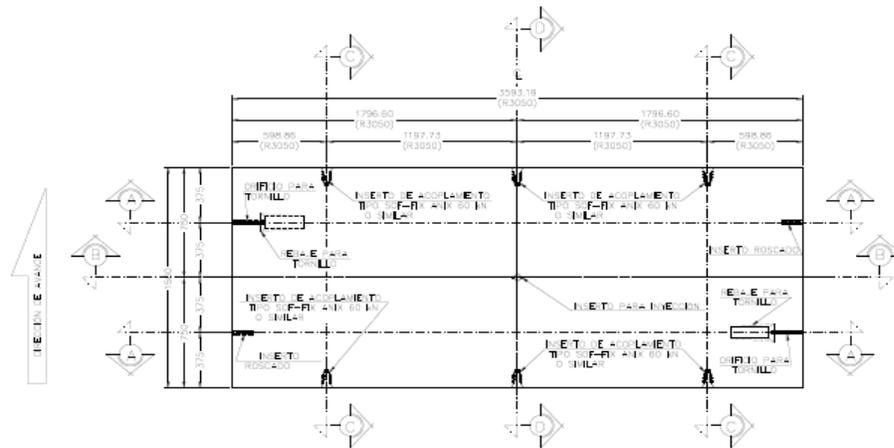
Vista superior en planta de la dovela A1 (cara exterior del túnel).
